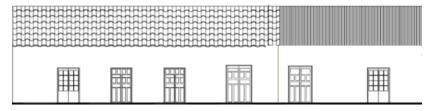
Inmuebles en fachada continua. Fuente: GEDOC CMN.
